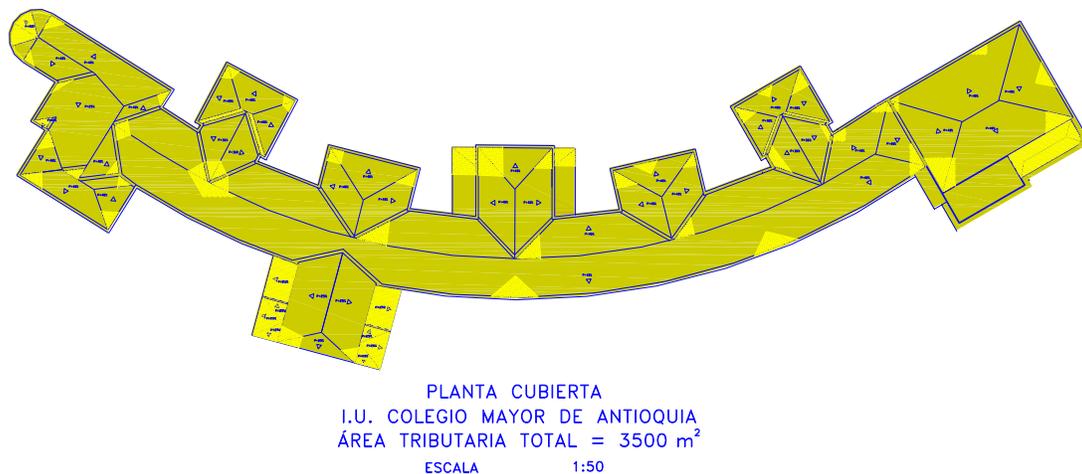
Plano planta de cubiertas de la I.U. Colegio Mayor de Antioquia
